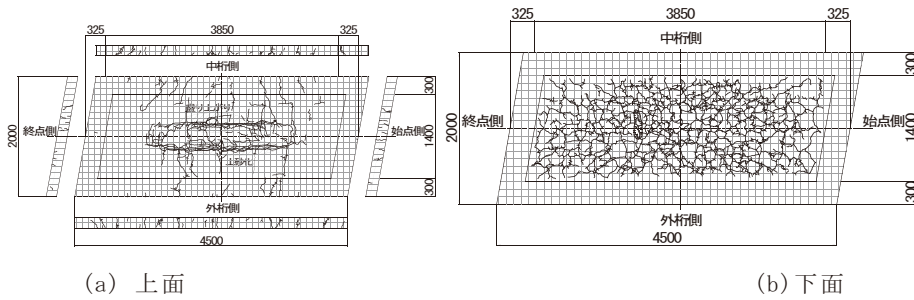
試験後(20,050回走行)床版ひび割れ図
